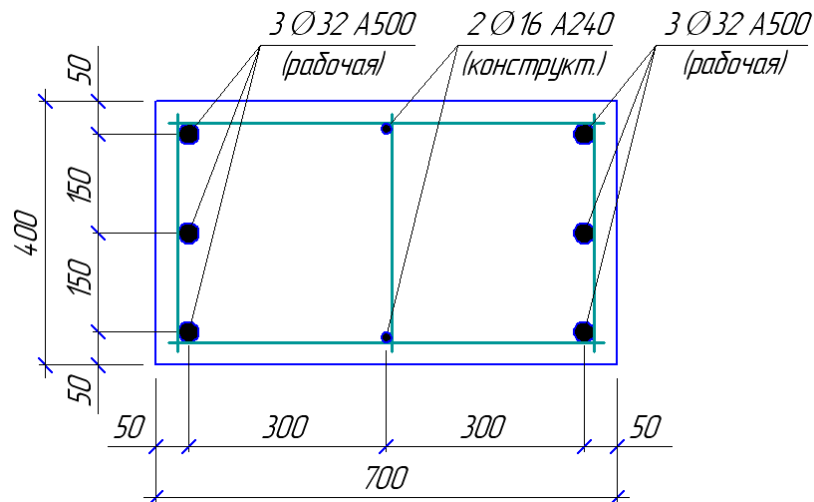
Армирование сечения внецентренно сжатого элемента (пример)
